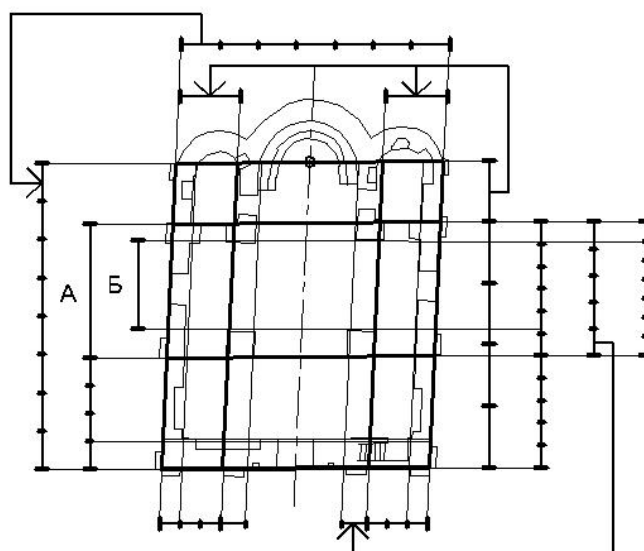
Разбивка плана на строительной площадке и определение дополнительных размеров.
